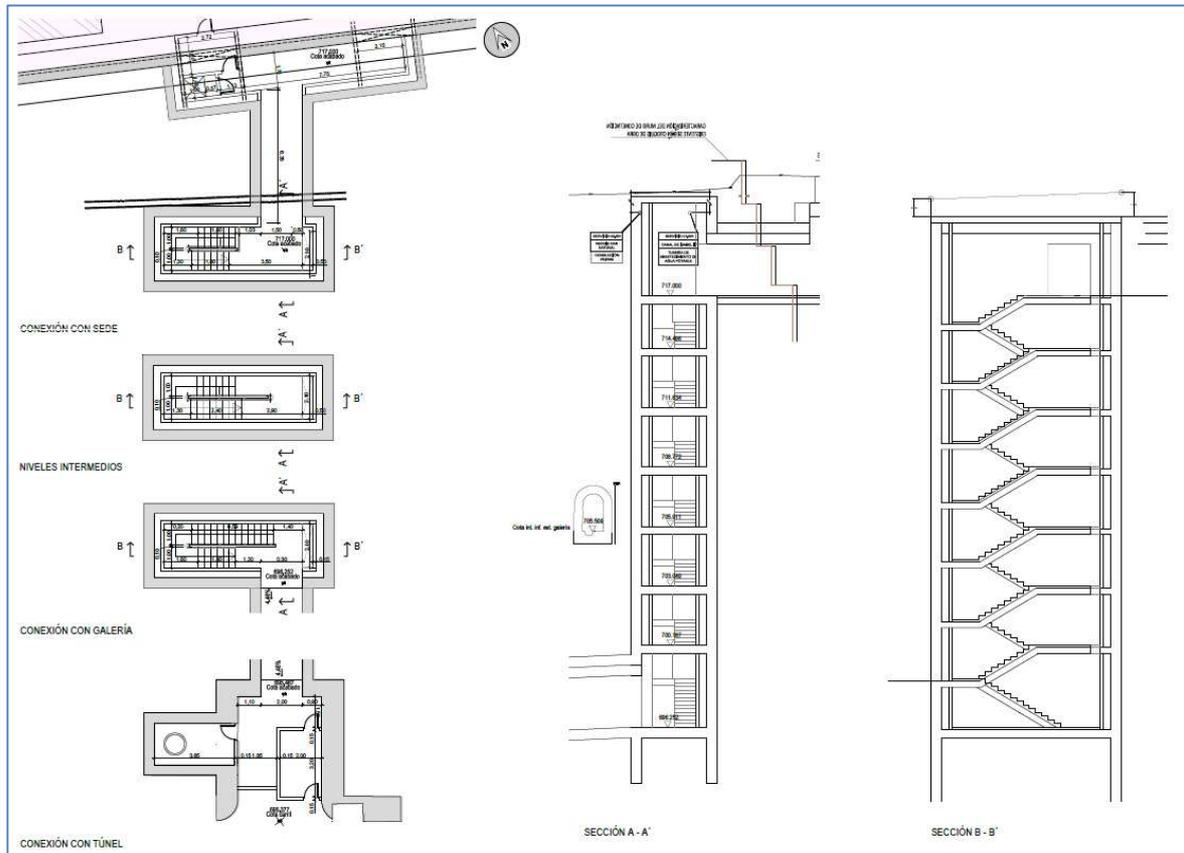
Sección de galería Línea 9 – Edificio 1.
